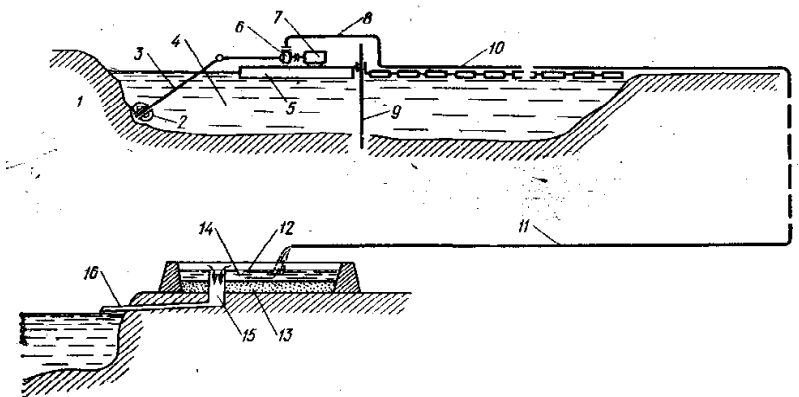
Общая схема разработки грунта земснарядом: 1 – забой; 2 – рыхлитель; 3 – рама (стрела) с всасывающим устройством; 4 – водоём; 5 – понтон; 6 – грунтовой насос; 7 – двигатель привода грунтового насоса; 8 – напорный пульпопровод; 9 – свайный аппарат; 10 – поплавки для удержания пульпопровода; 11 – сухопутная часть пульпопровода; 12 – карта намыва; 13 – осевший грунт; 14 – осветленная вода; 15 – шандорный колодец; 16 – лоток для сброса осветленной воды.
